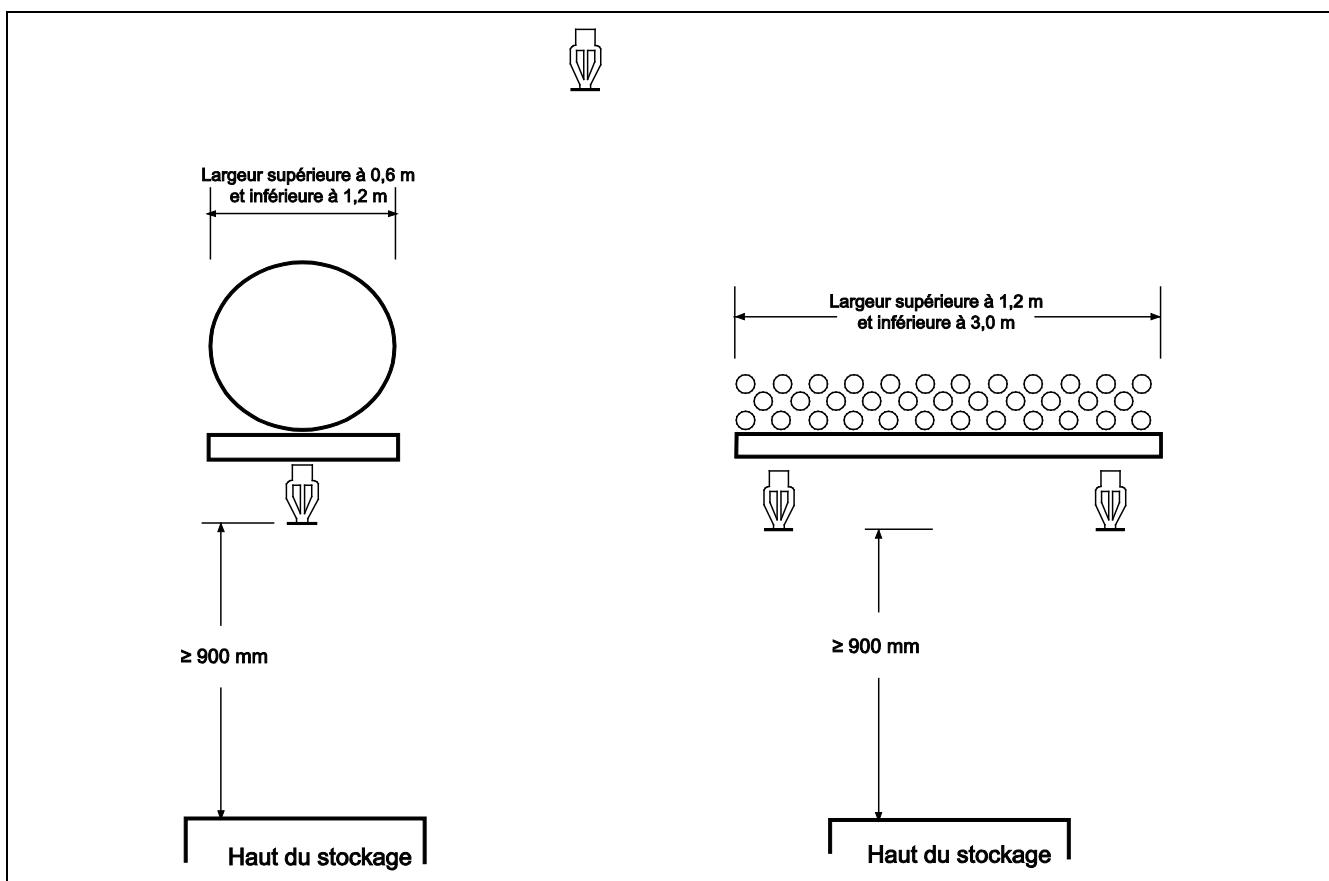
Sprinkleurs supplémentaires installés sous des obstructions non pleines, non plates ou non continues d'une largeur comprise entre 0,6 m et 3,0 m.
